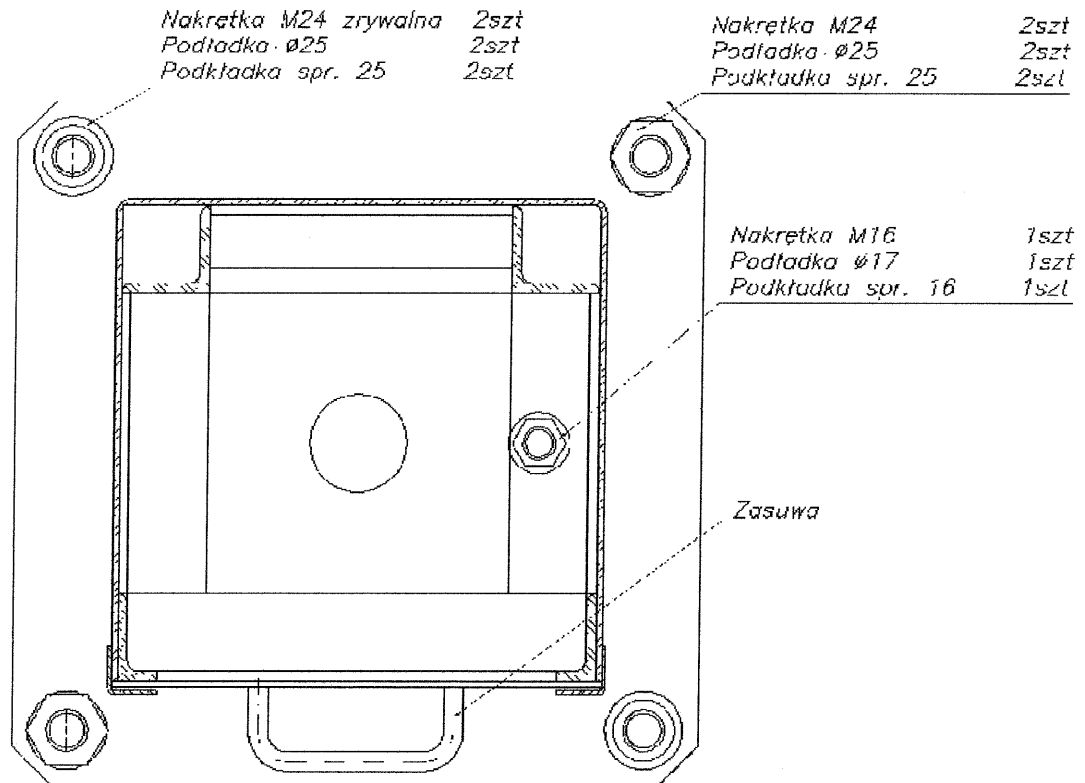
Fundament prefabrykowany B-71 firmy „Rosa”
